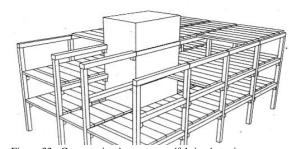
Construction à ossature préfabriquée typique avec noyau central pour la stabilité.
